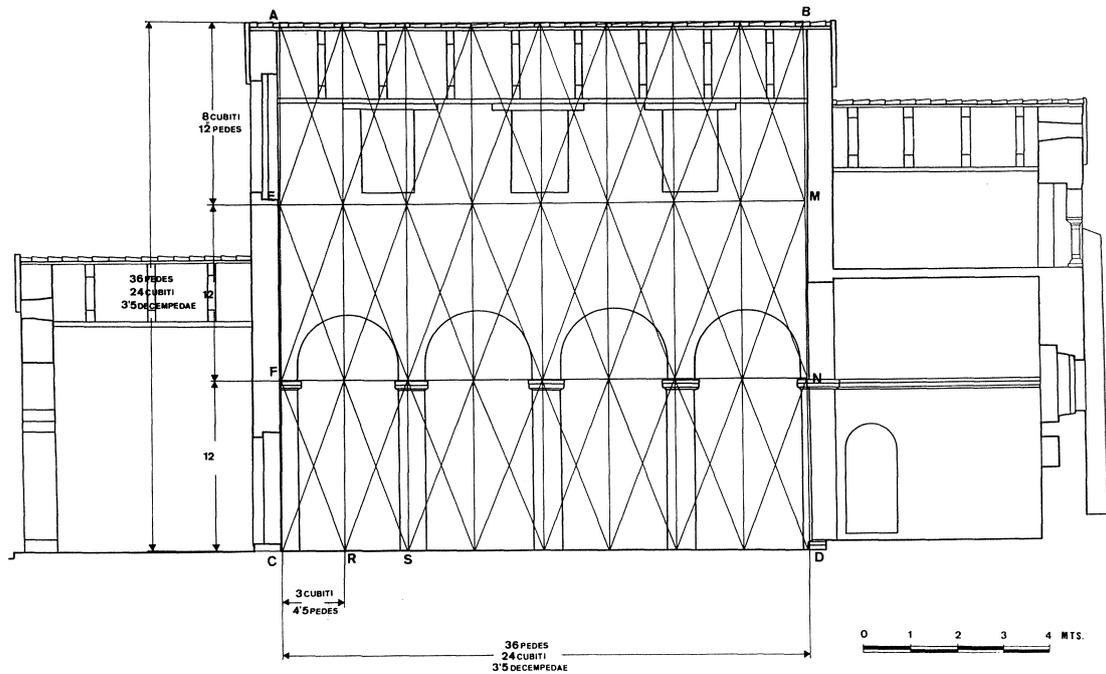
San Pedro de Nora. Sección longitudinal hacia el Norte. Reticula modular con indicación de la división tripartita de la altura de la nave central.
